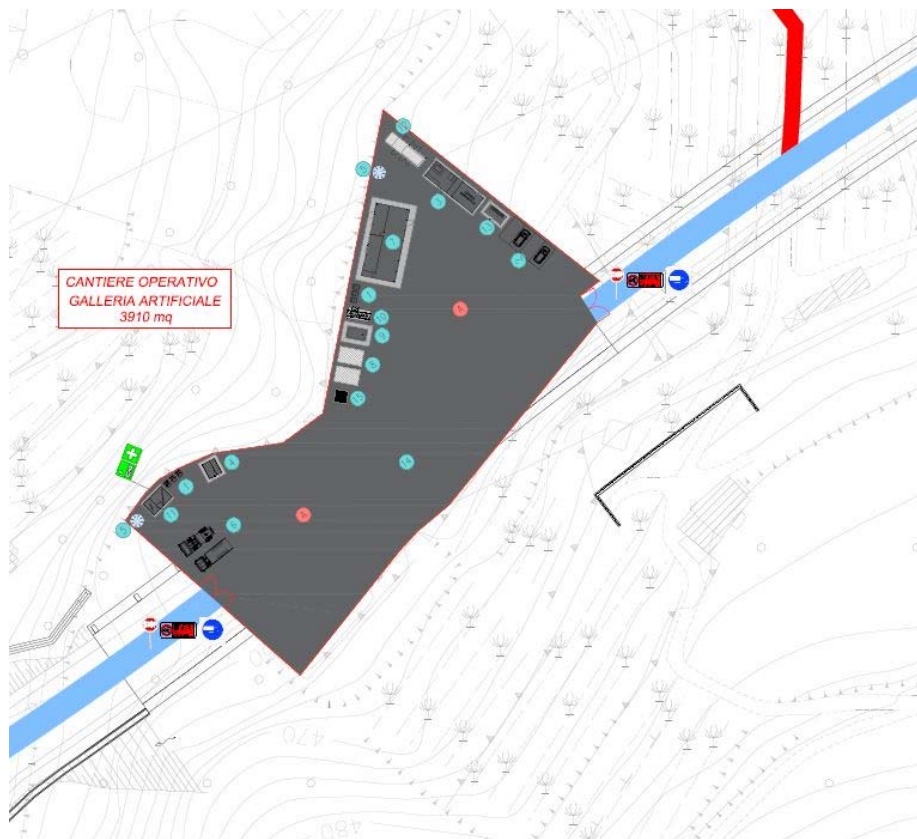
AREA CANTIERE GALLERIA ARTIFICIALE
